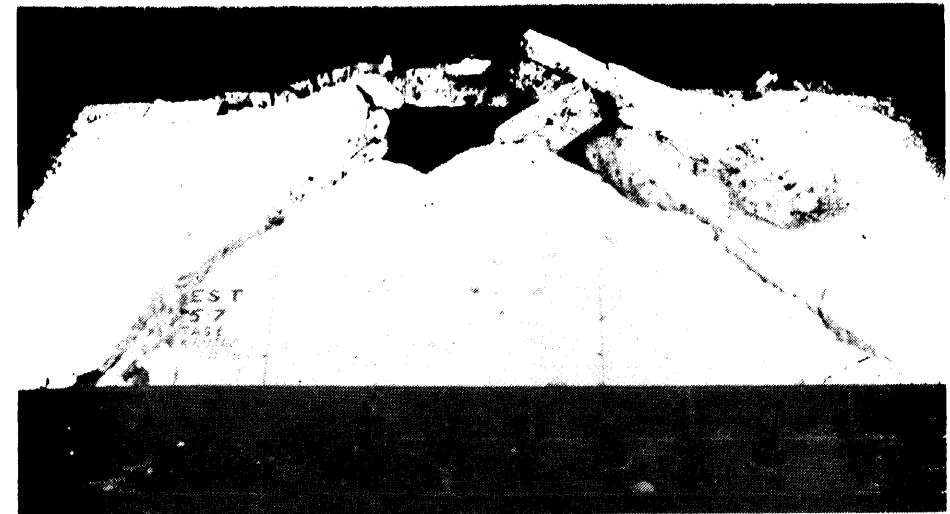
Slab beton bertulang segiempat pada keadaan *rupture*. (Tes oleh Nawy dkk.)
